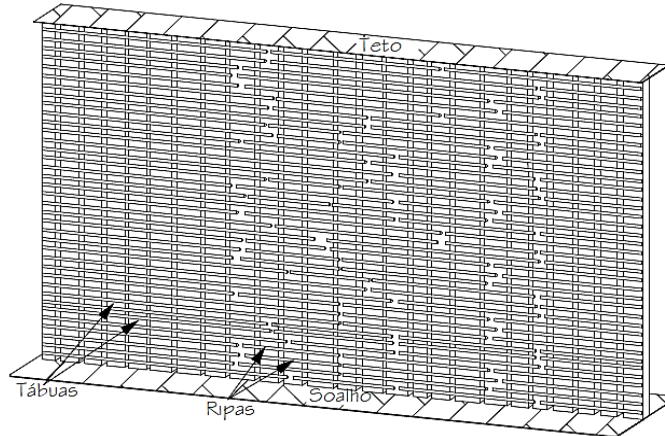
Esquema da solução estrutural de madeira de uma parede interior, tipologia A
